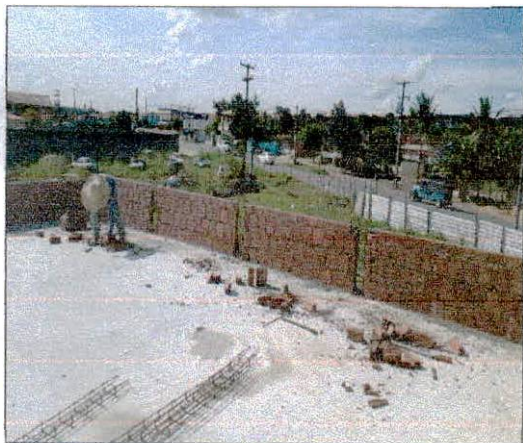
Execução de pilares e vigas de concreto armado das platibandas.
